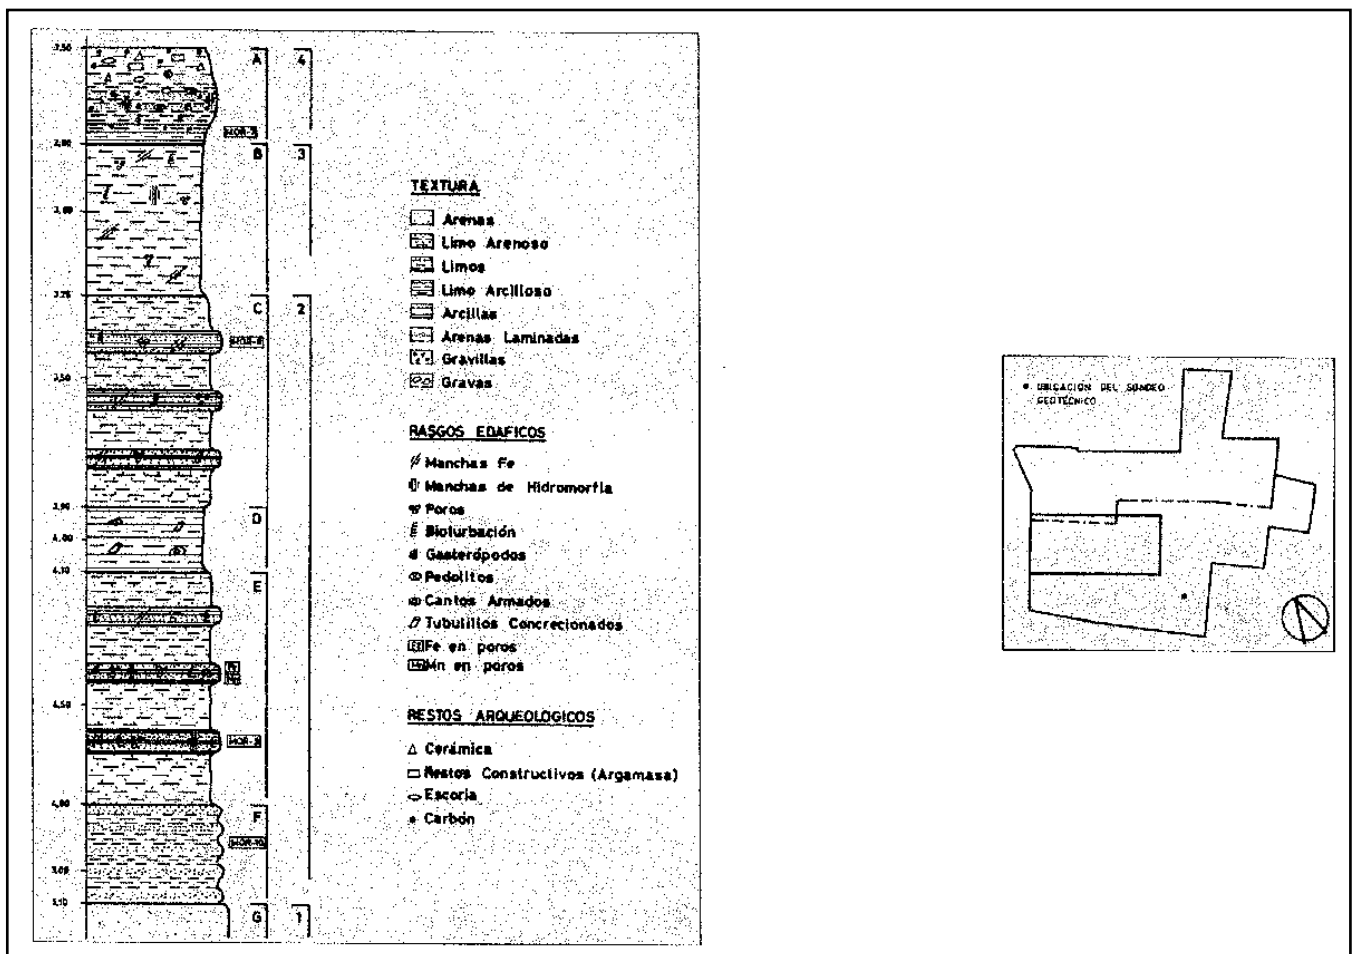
Sondeo geotécnico. Planta de ubicación y perfil
